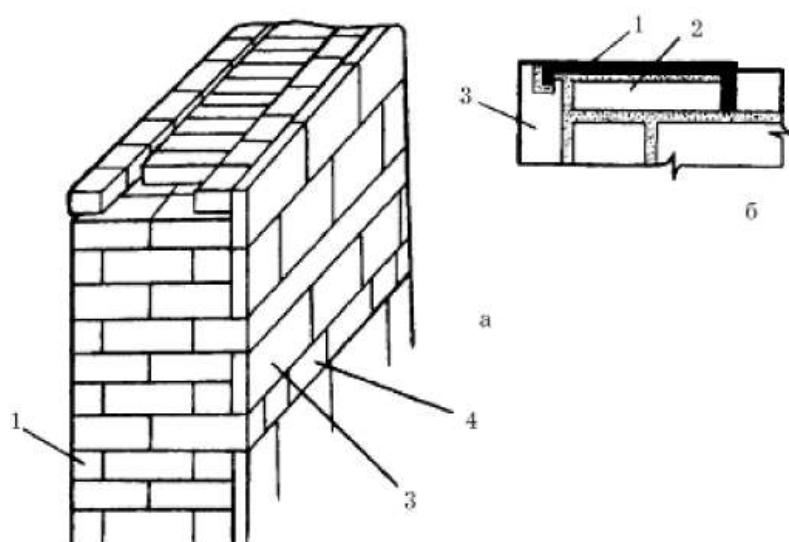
Кладка стен с одновременной облицовкой силикатными или керамическими плитами: а – общий вид; б – фрагмент кладки: 1 – анкер; 2 – пирон; 3 – прислонные облицовочные плиты; 4 – прикладной ряд плит
